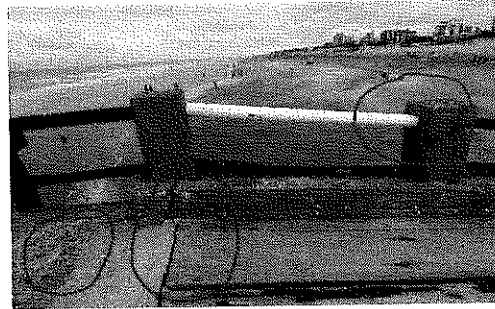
Desgaste Superficial, Deterioro Baranda, Detalle Juntas
